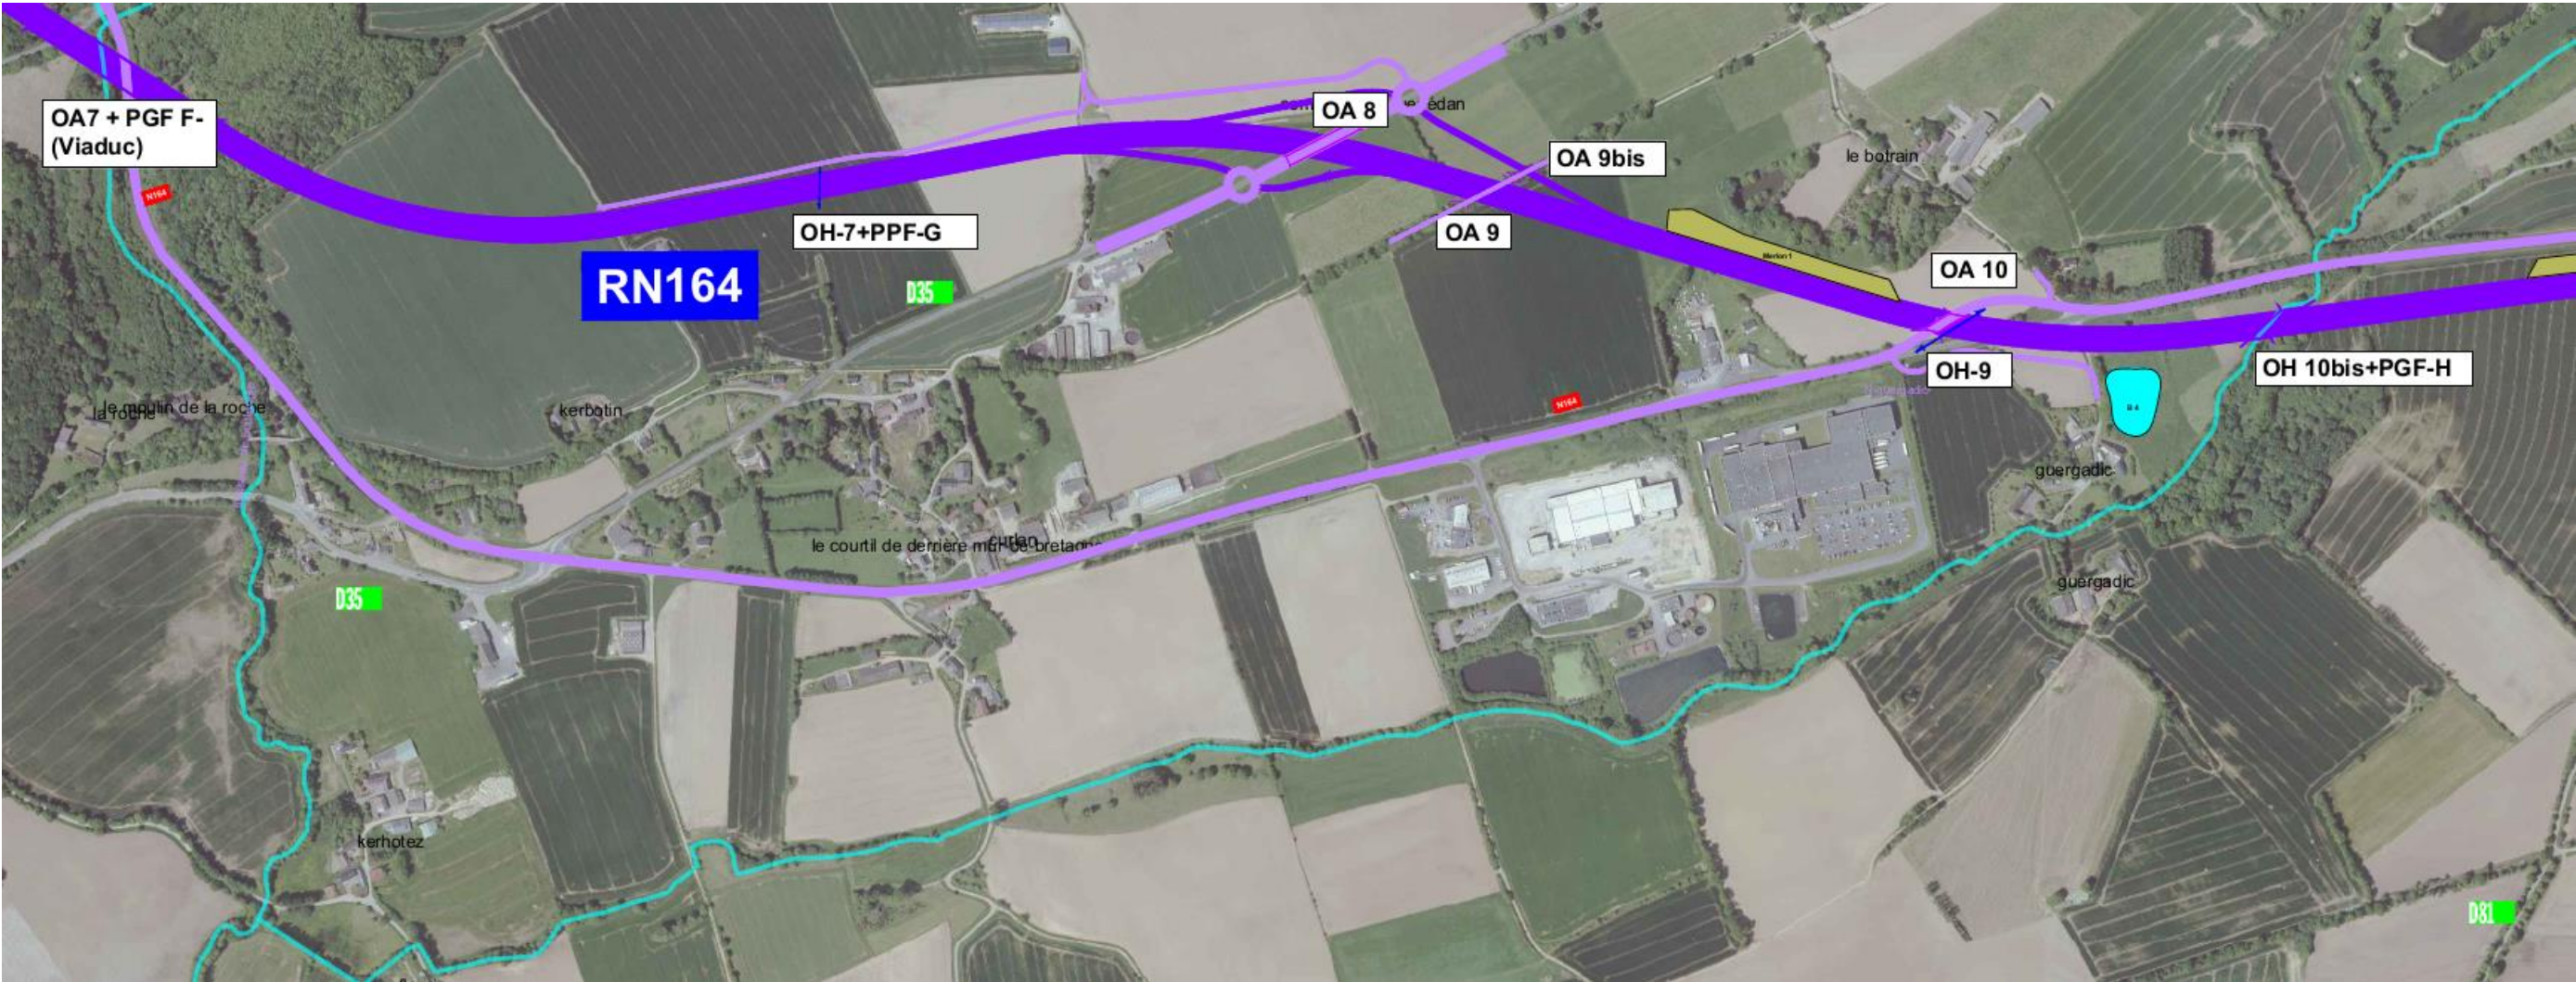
Plan général de travaux – Planche 3 (source : SIR)
